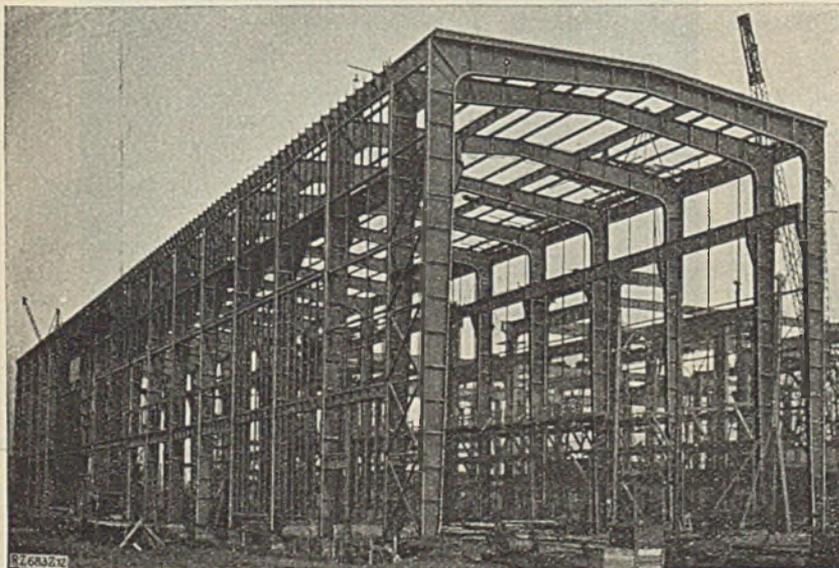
Eisenkonstruktion des Turbinenhauses.
